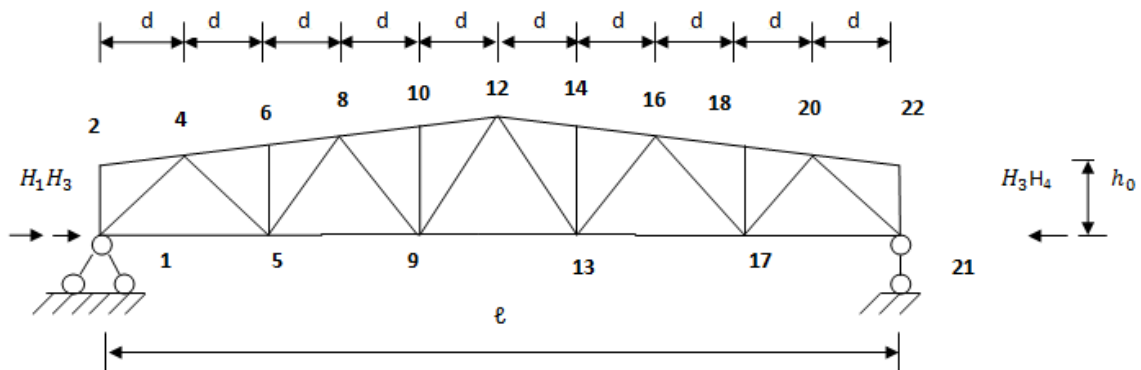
Схема нумерации узлов фермы – 10d. Номера 3; 7; 11; 15; 21 условно не показаны. Схема нагрузок рамного распора
